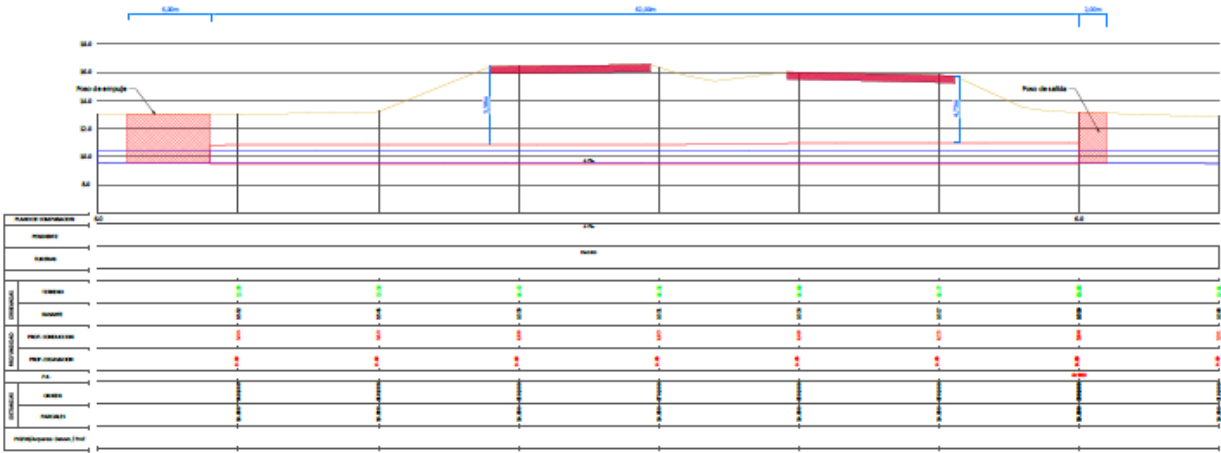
Alzado tramo en hinca cruce con AP-7.
